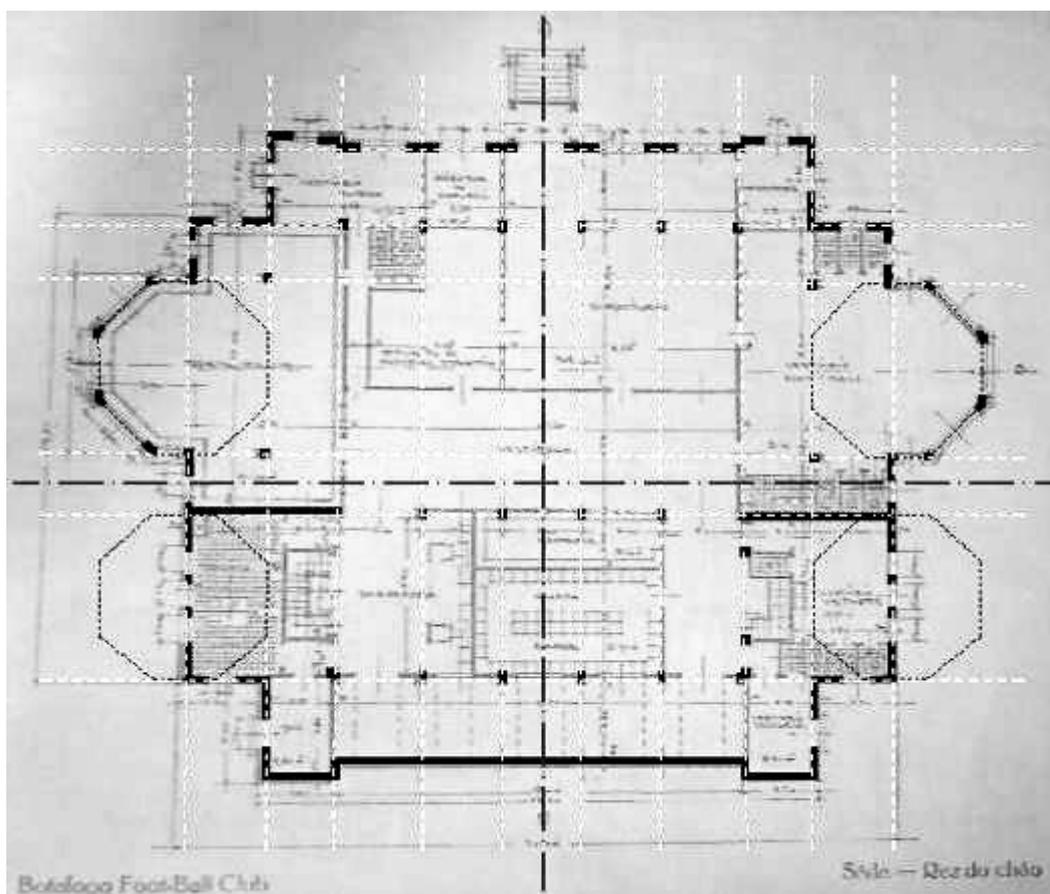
Intervenção digital sobre a Planta do 1º Pavimento. Em destaque, os eixos de simetria e as simulações de rebatimento.
